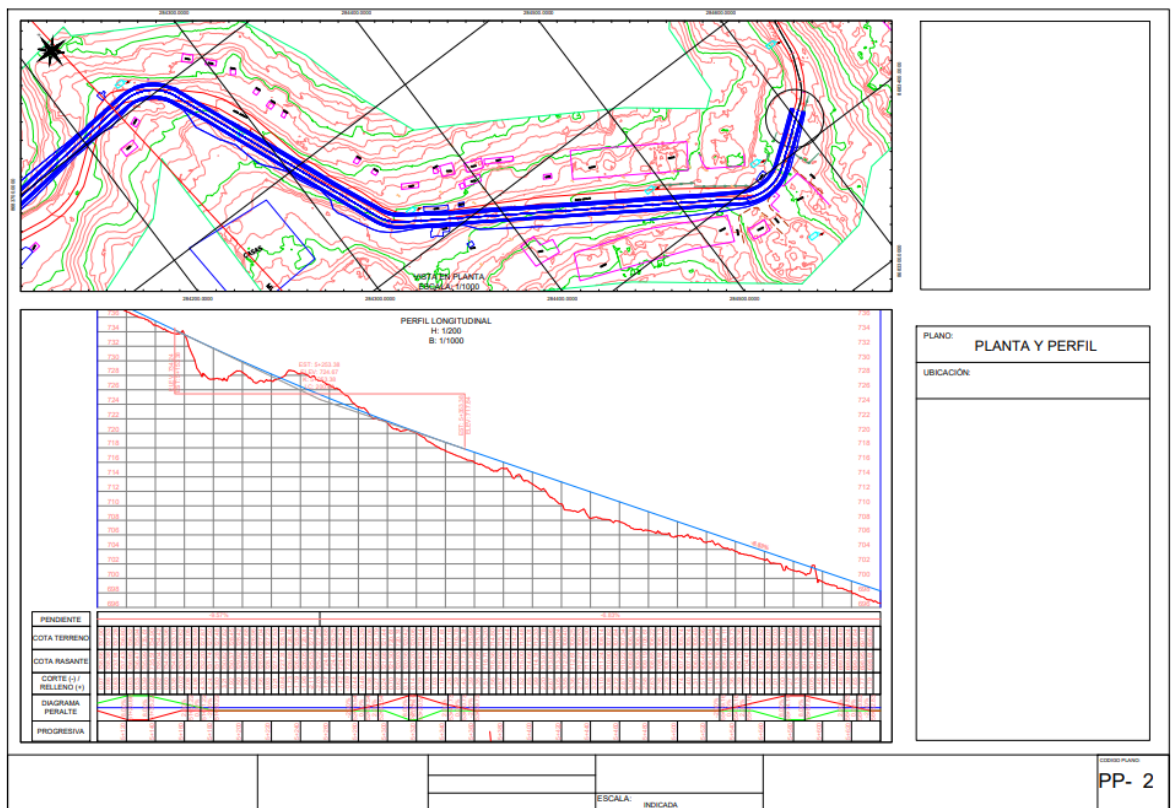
Segunda parte de los planos de planta y perfil en civil 3D.
